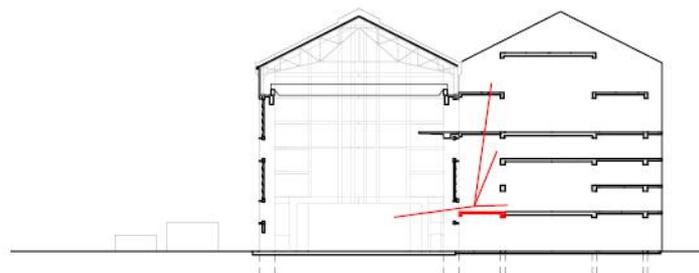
Coupe, position du jumeau (rouge = rue traversante connectant les espaces principaux
